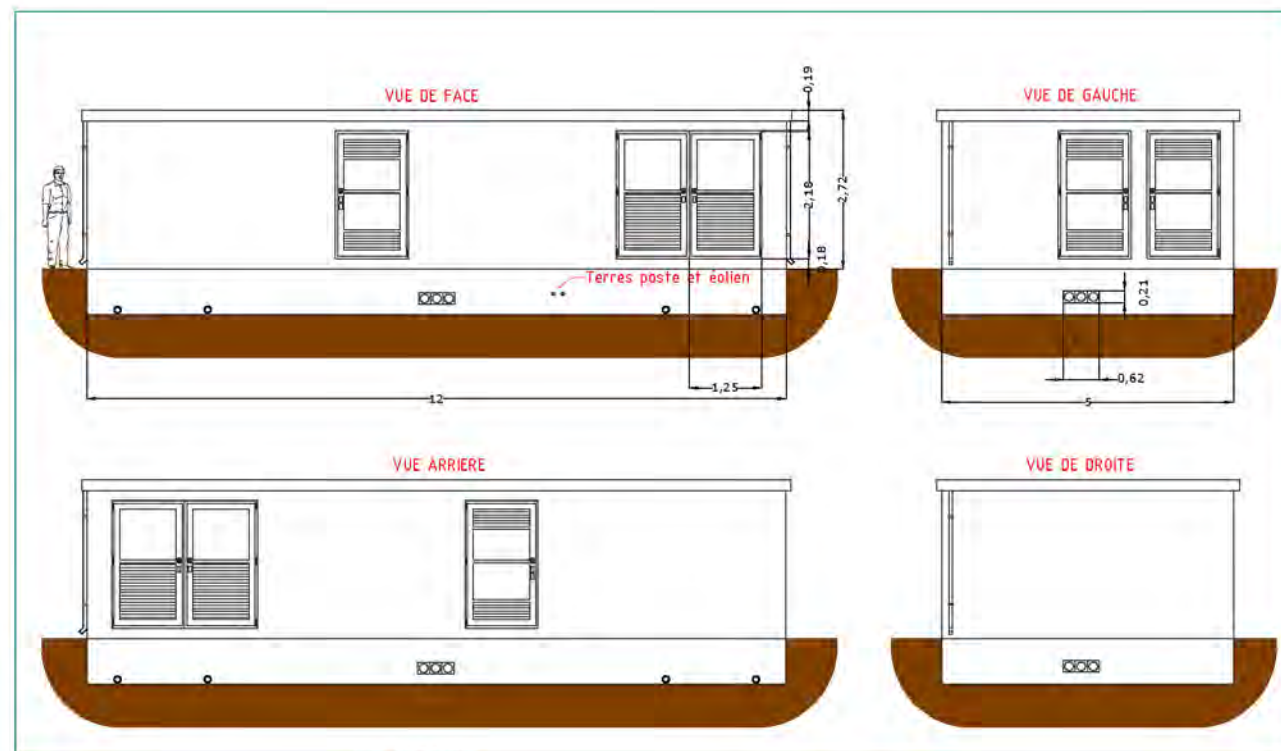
plans des façades et des toitures des postes de livraison [source : Développeur]
